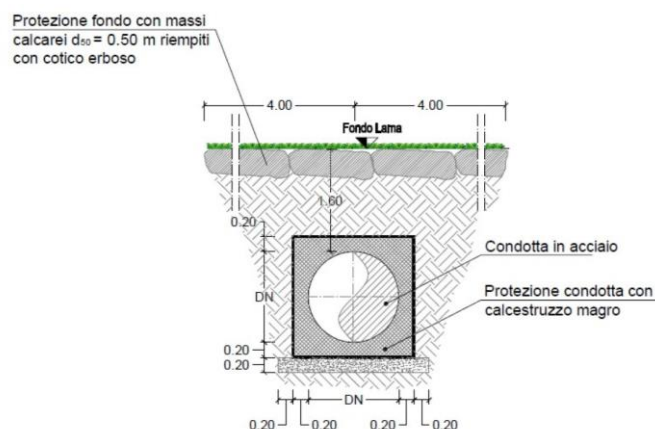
Sezione longitudinale reticolo con protezione in massi e annegamento della condotta in calcestruzzo magro.
